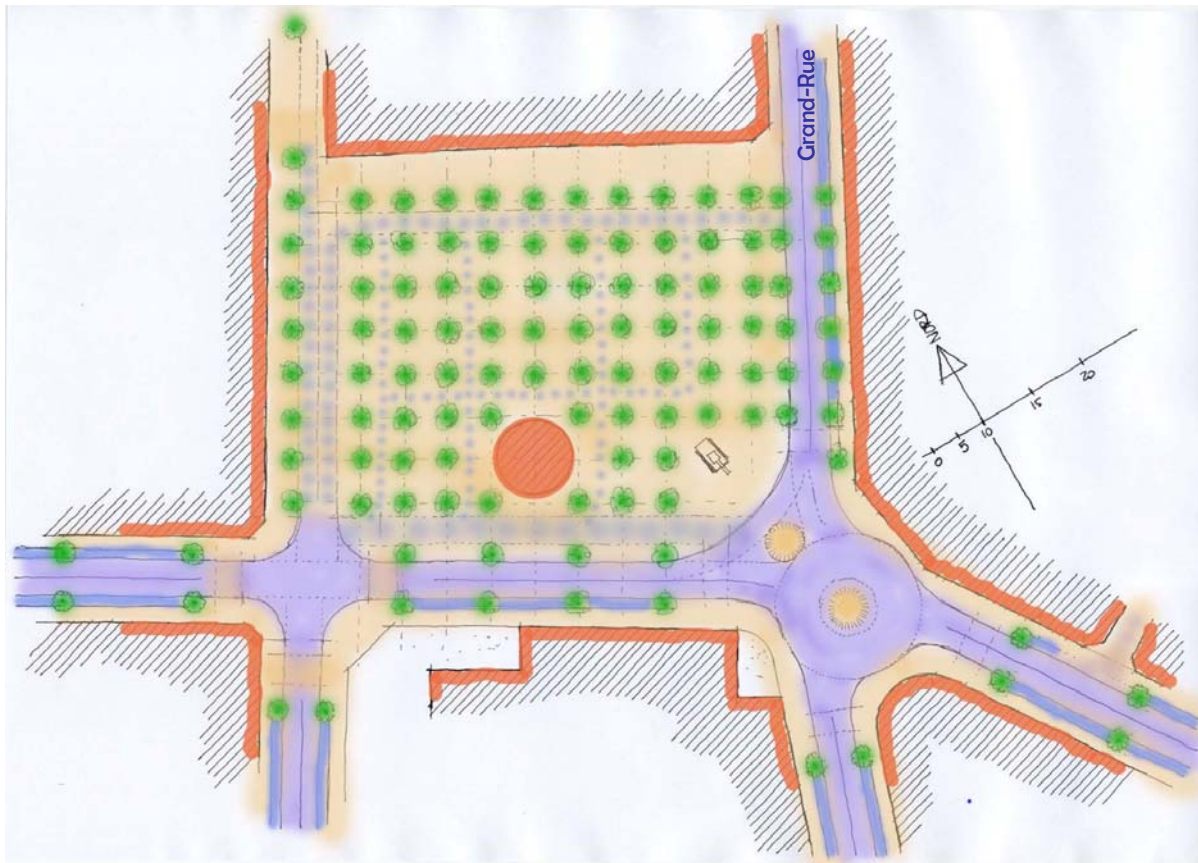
Place Mac Auliffe : Proposition d'aménagement (vue en plan)
